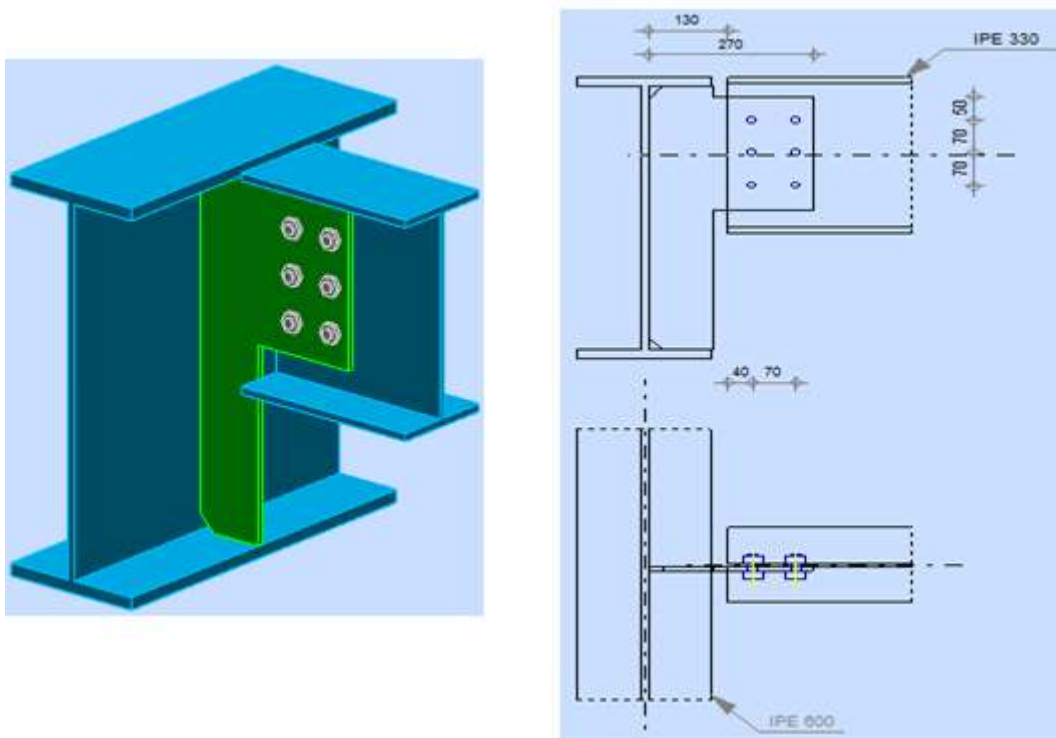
Représentation de l'assemblage poutre IPE 600 – solive IPE 330
